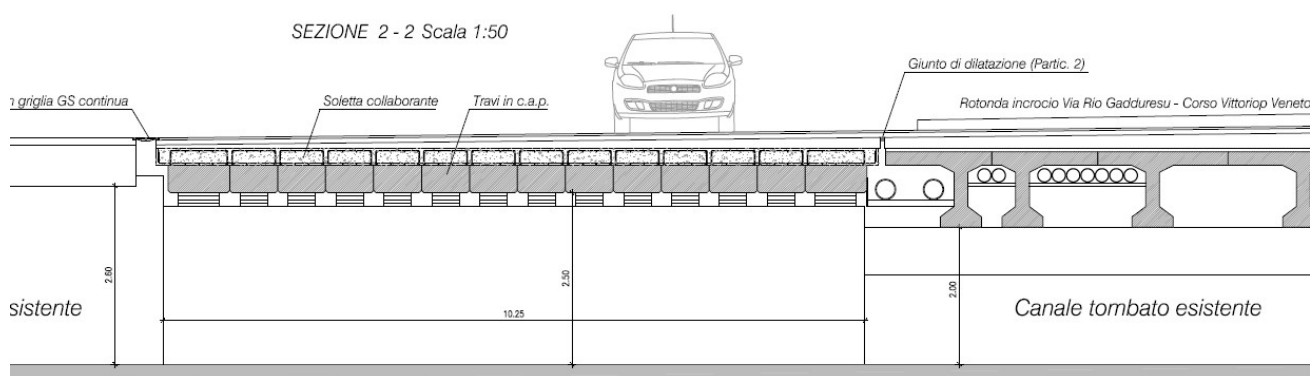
estratto da tavola 3 progetto 'Demolizione e ricostruzione ponte sul canale tombato Corso Vittorio Veneto': il canale tombato esistente - parte integrante del viadotto realizzato dalla Provincia - a valle del ponte in progetto, ha una trave con intradosso a 2 m dal fondo, non valutato nelle simulazioni idrauliche del Rio Gadduresu: . Si rimanda agli elaborati di progetto definitivo 'Demolizione e ricostruzione ponte sul canale tombato via Vittorio Veneto' .
